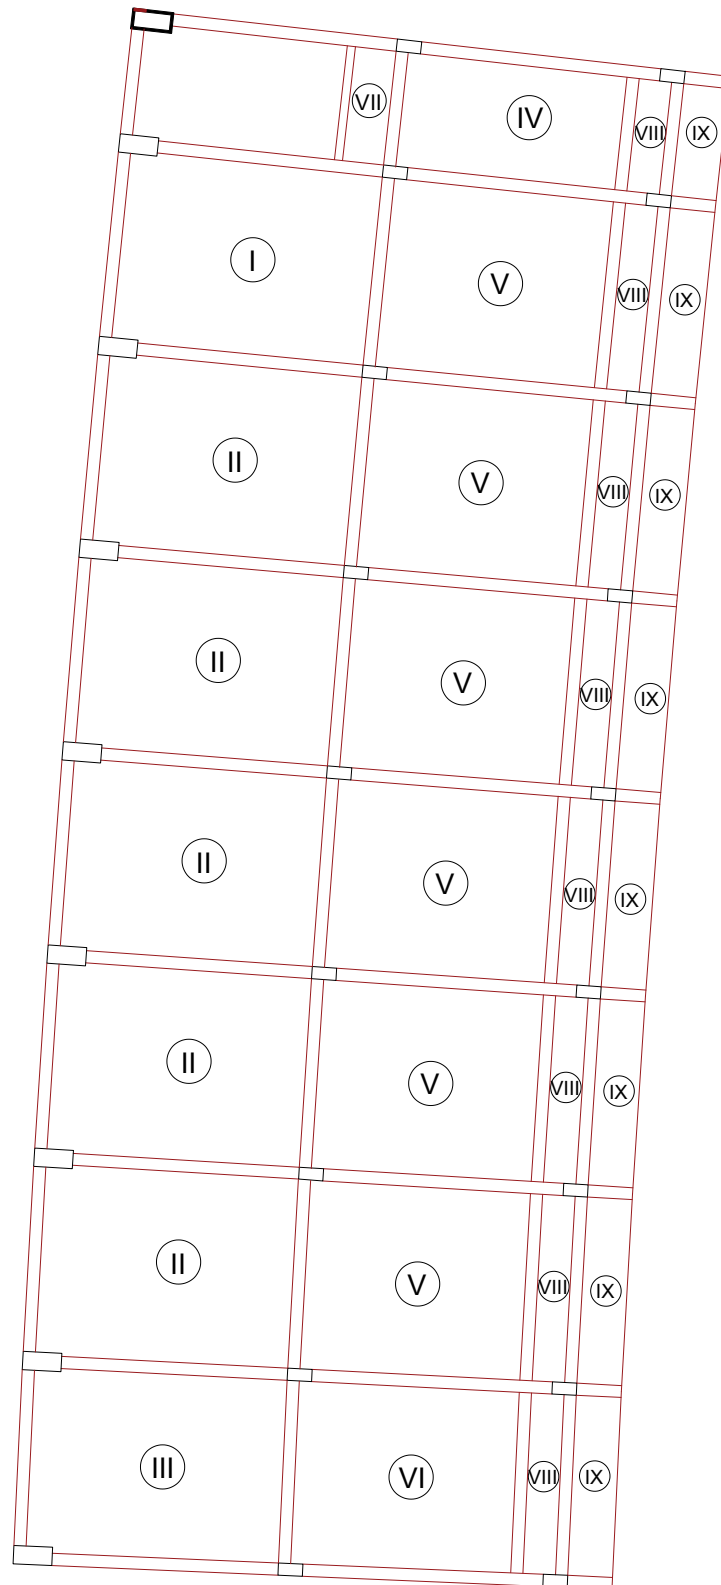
Distribución en Planta de Paños de Losas – Bloque A
